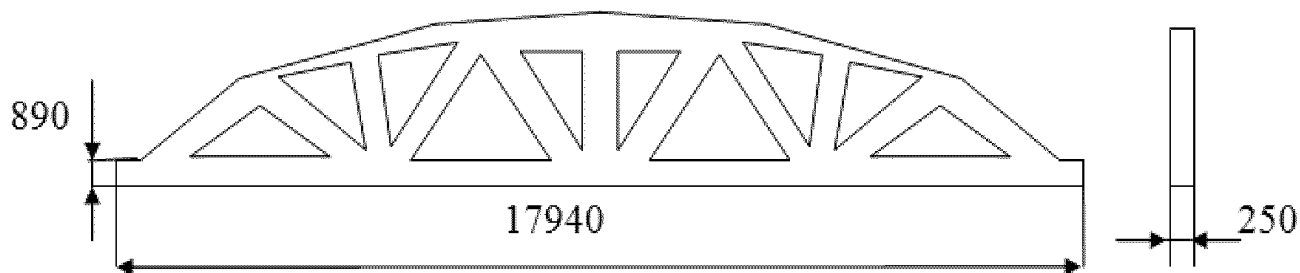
Габаритные размеры железобетонных ферм
